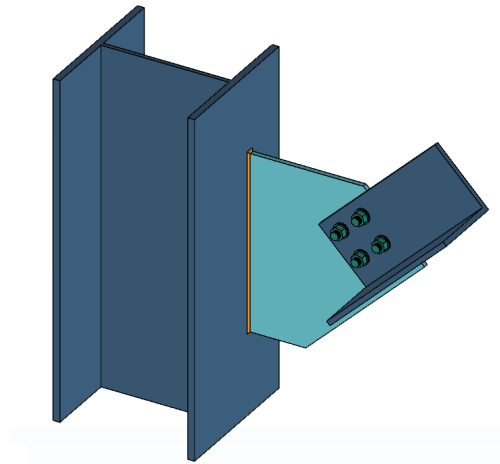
Assemblage d'une cornière de contreventement sur un poteau
